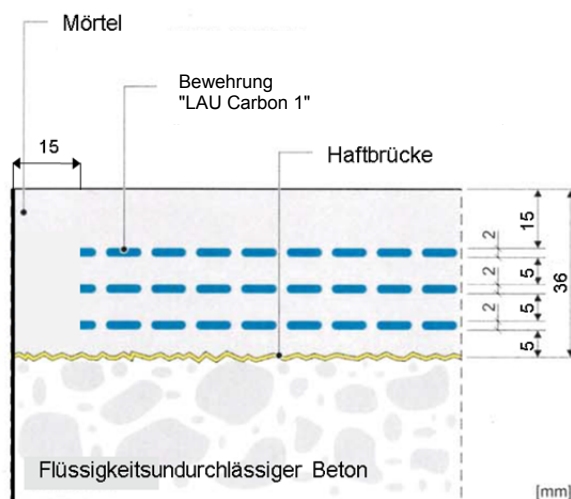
Beispielhafter Einbau des Carbonbetonsystems für eine Flüssigkeit mit  $e_{tk} = 13$  mm mit drei Lagen textiler Bewehrung
